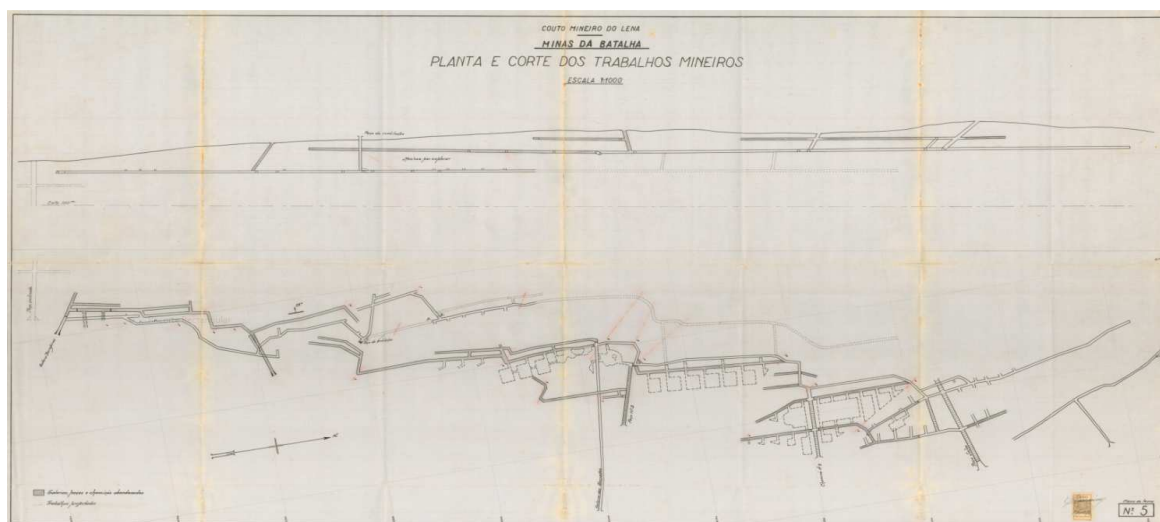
A mina de Alcanadas segundo Monteiro Conceição, 1932. Corte e planta escala 1:1.000. A planta mostra a posição relativa das câmaras de exploração projetadas. Cortesia AHDGEG / LNEG.
